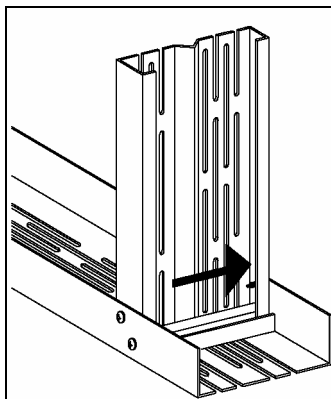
Крепление стержня на болтах и соединительном уголке.
